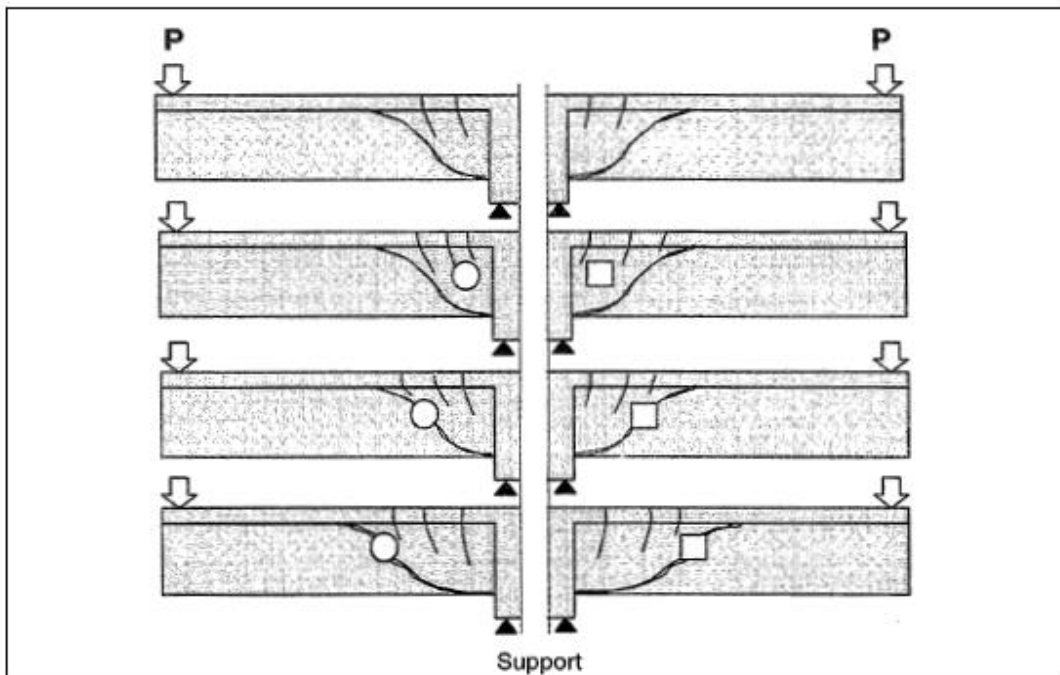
Falha típica de uma viga sem armadura de cisalhamento
